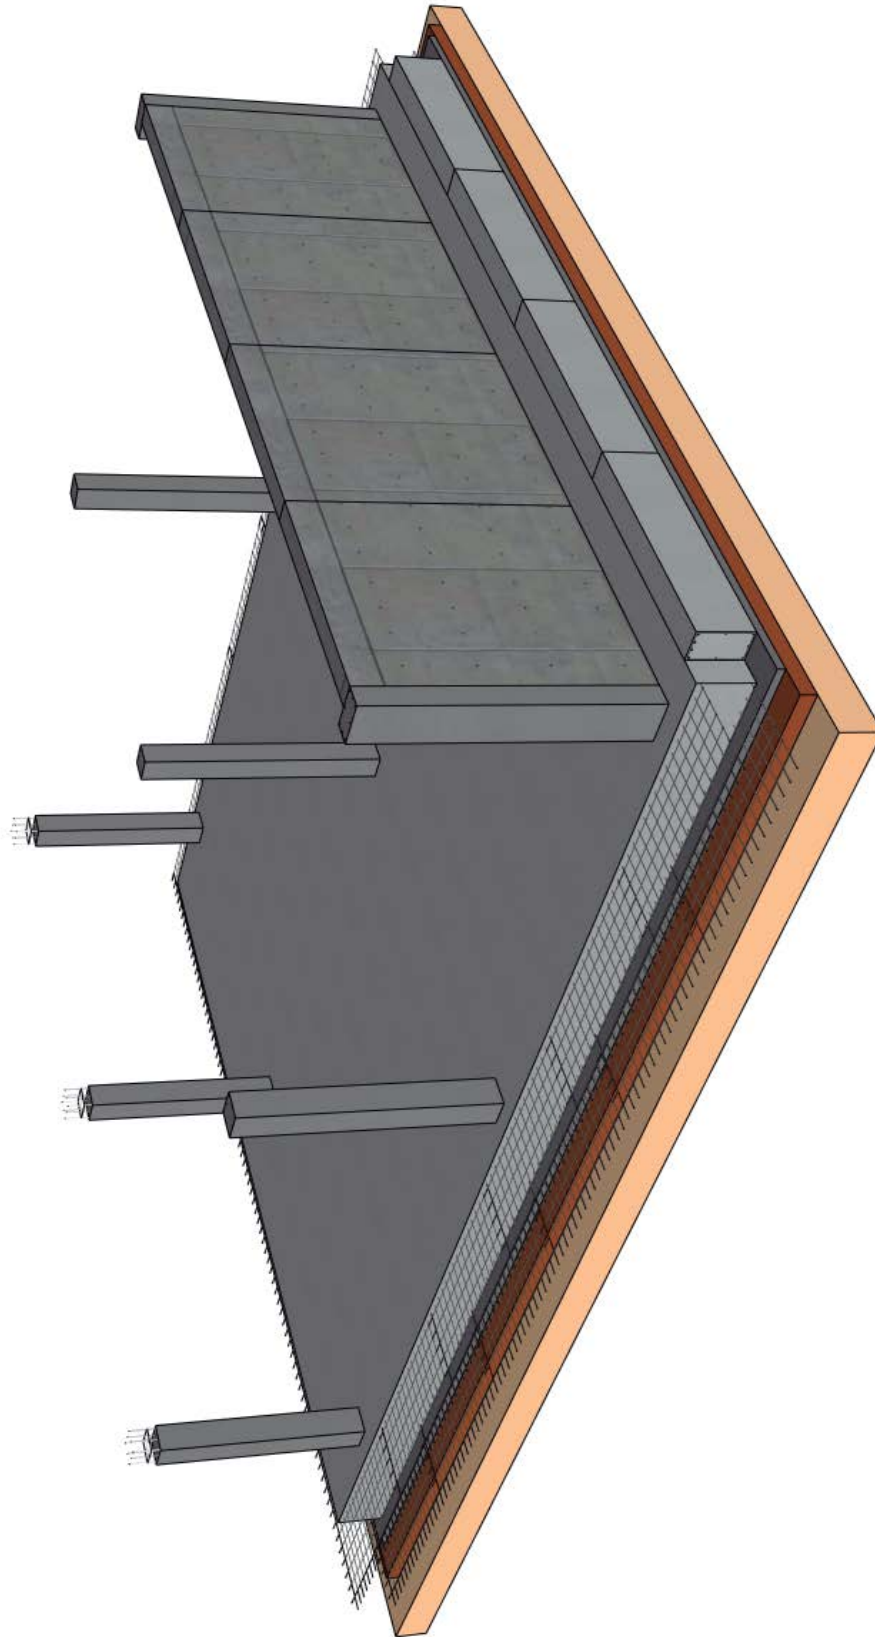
Hormigonado de los pilares y el muro perimetral de la planta sótano
